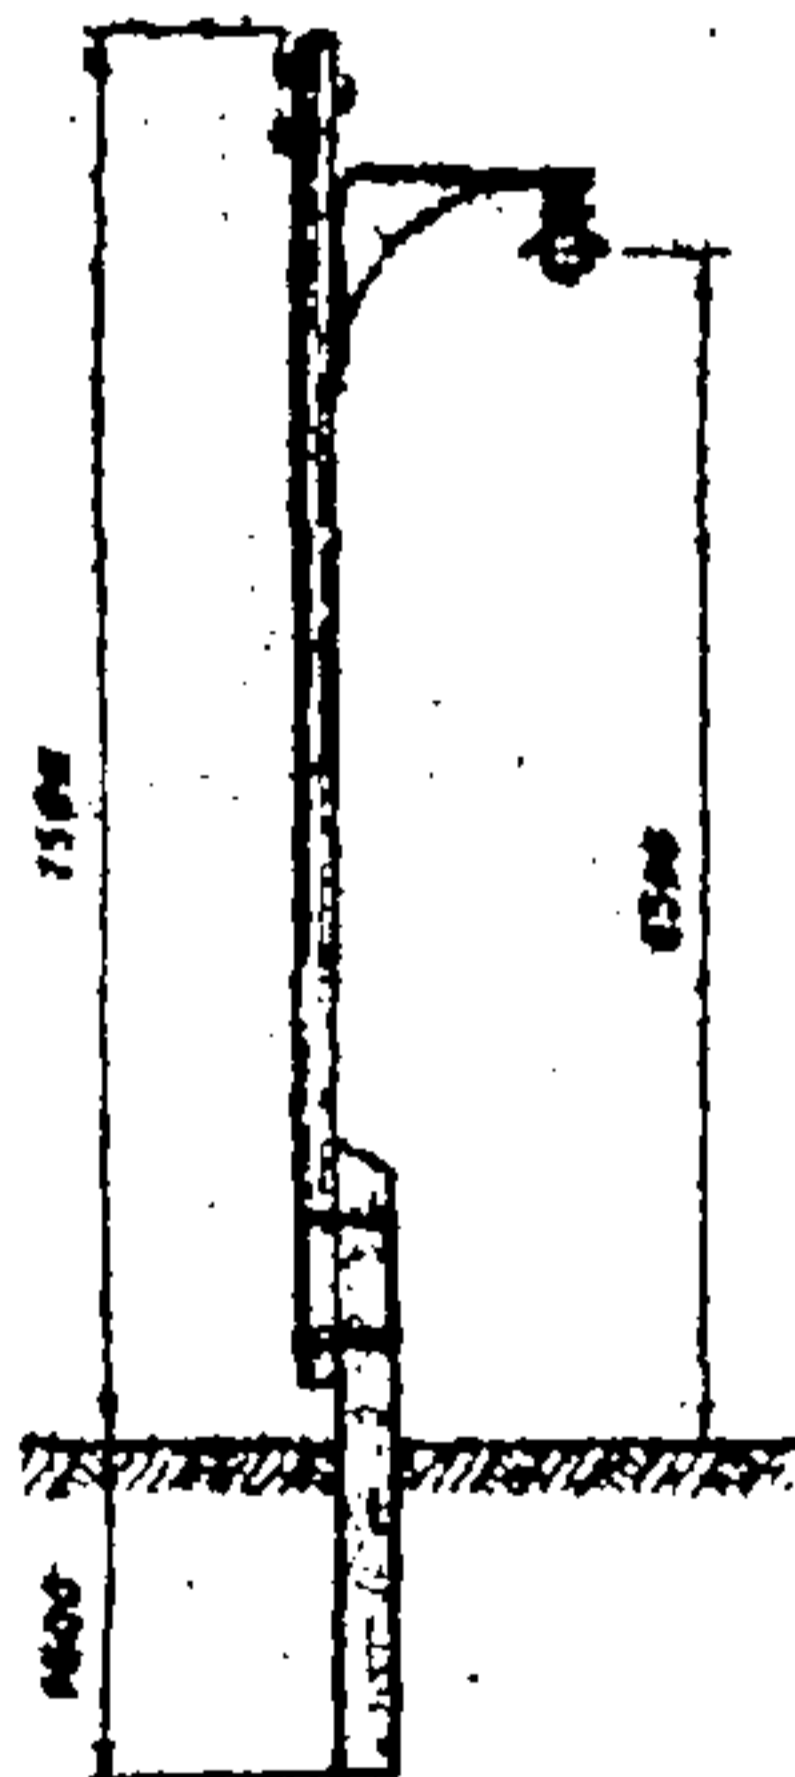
Размещение светильника охранного освещения на выносной опоре.
